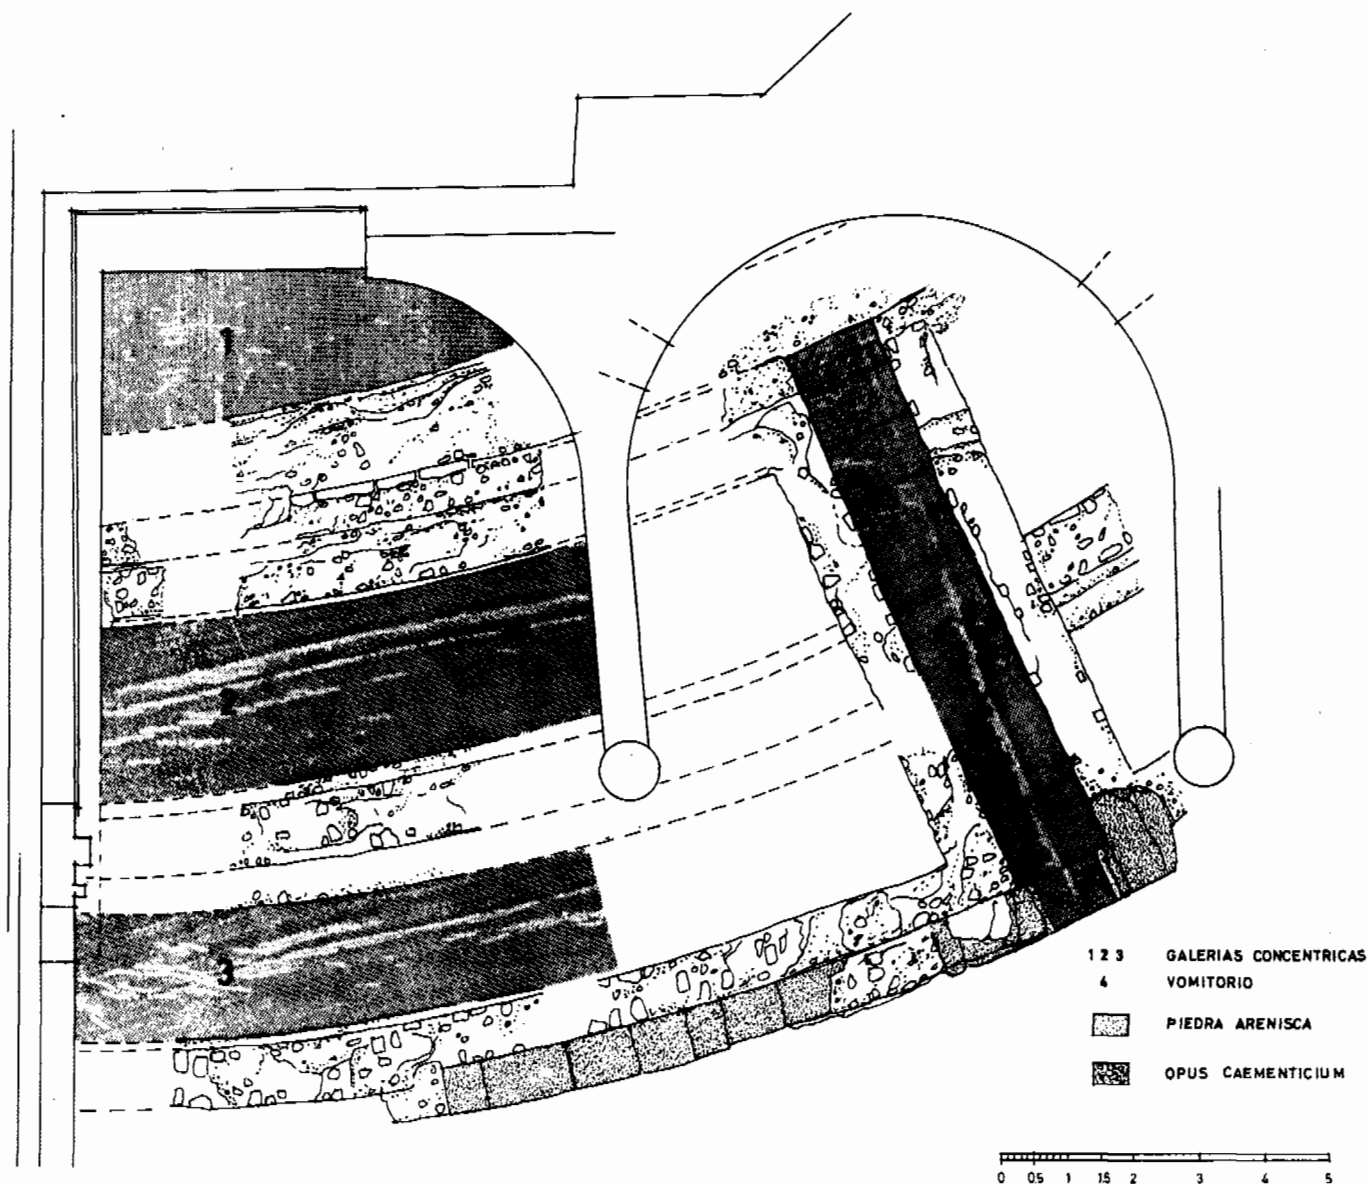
Restos de la estructura de la cavea en la zona alta: Catedral Vieja. Planta esquemática de conjunto sobre planimetría de excavación.
